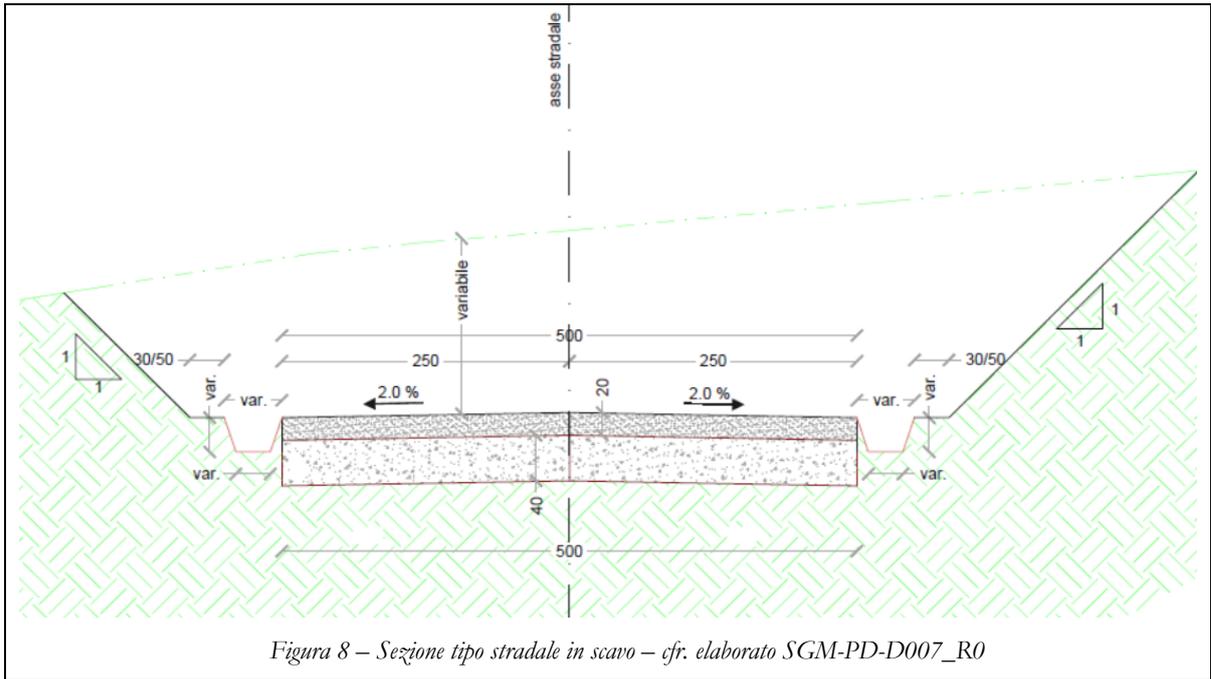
Sezione tipo stradale in scavo – cfr. elaborato SGM-PD-D007\_R0
